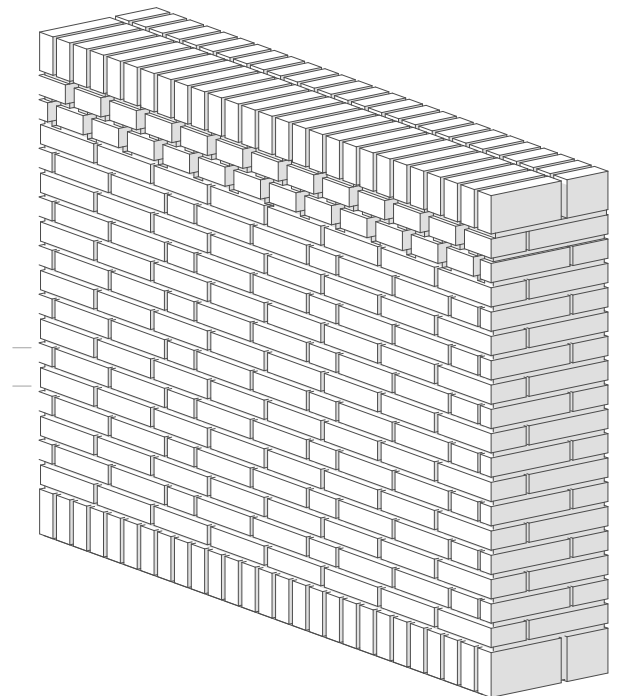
Ilustración del ladrillo en el detalle constructivo 2'.
